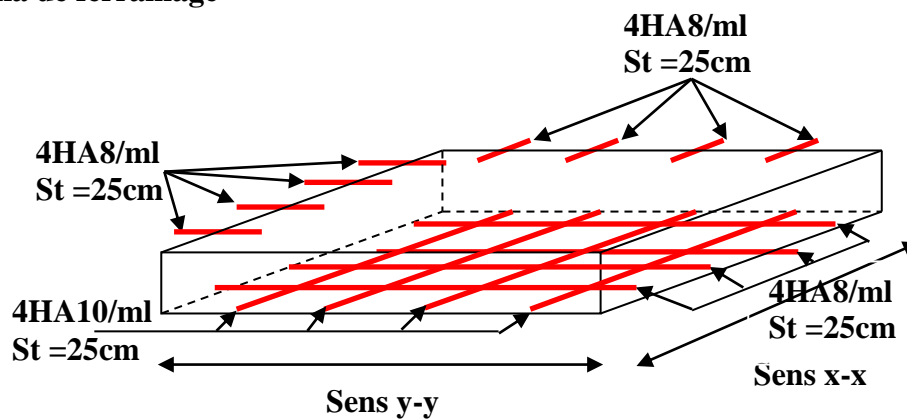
Schéma de ferrailage de la dalle pleine au-dessus de l'ascenseur.
